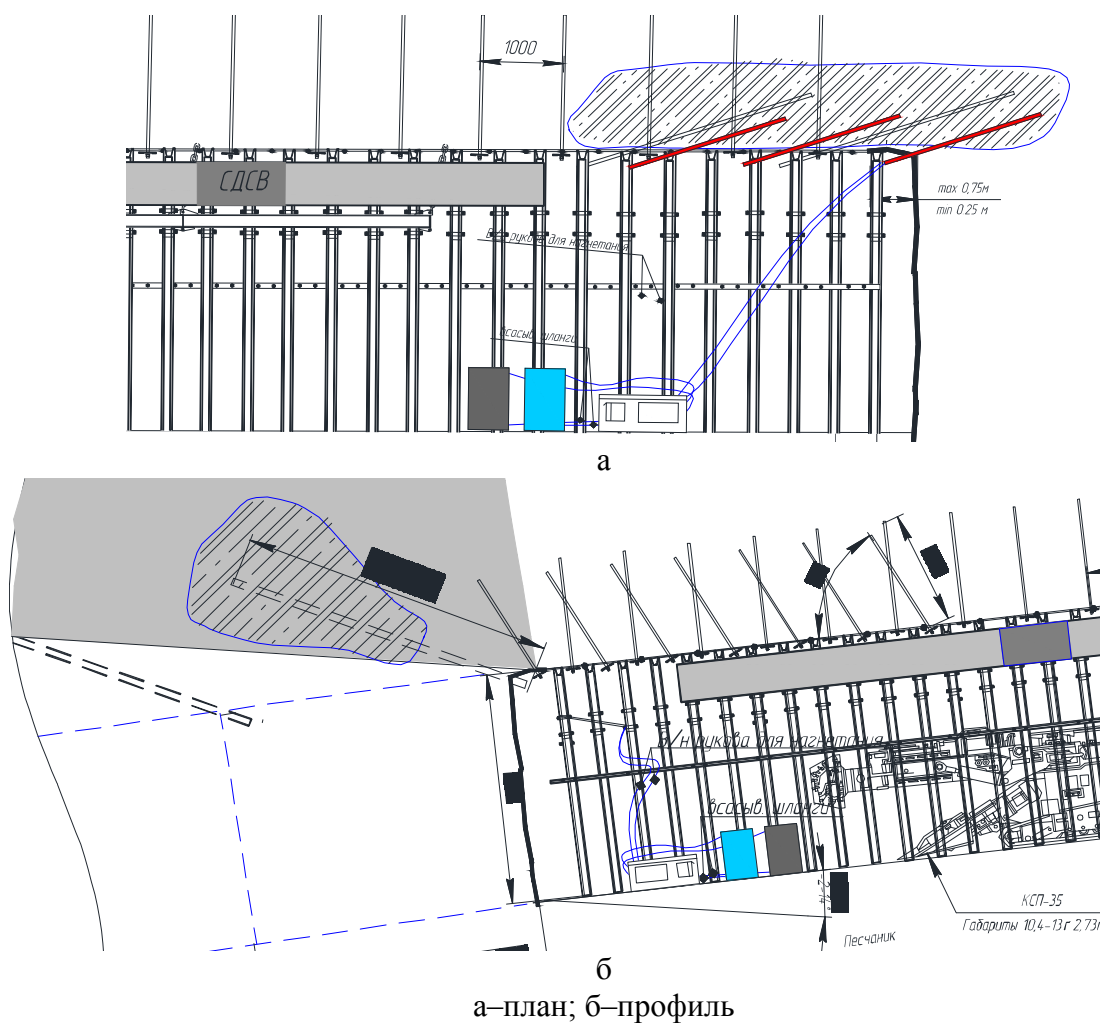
Технология крепления при неустойчивой кровле устанавливаются опережающие наклонные анкера
